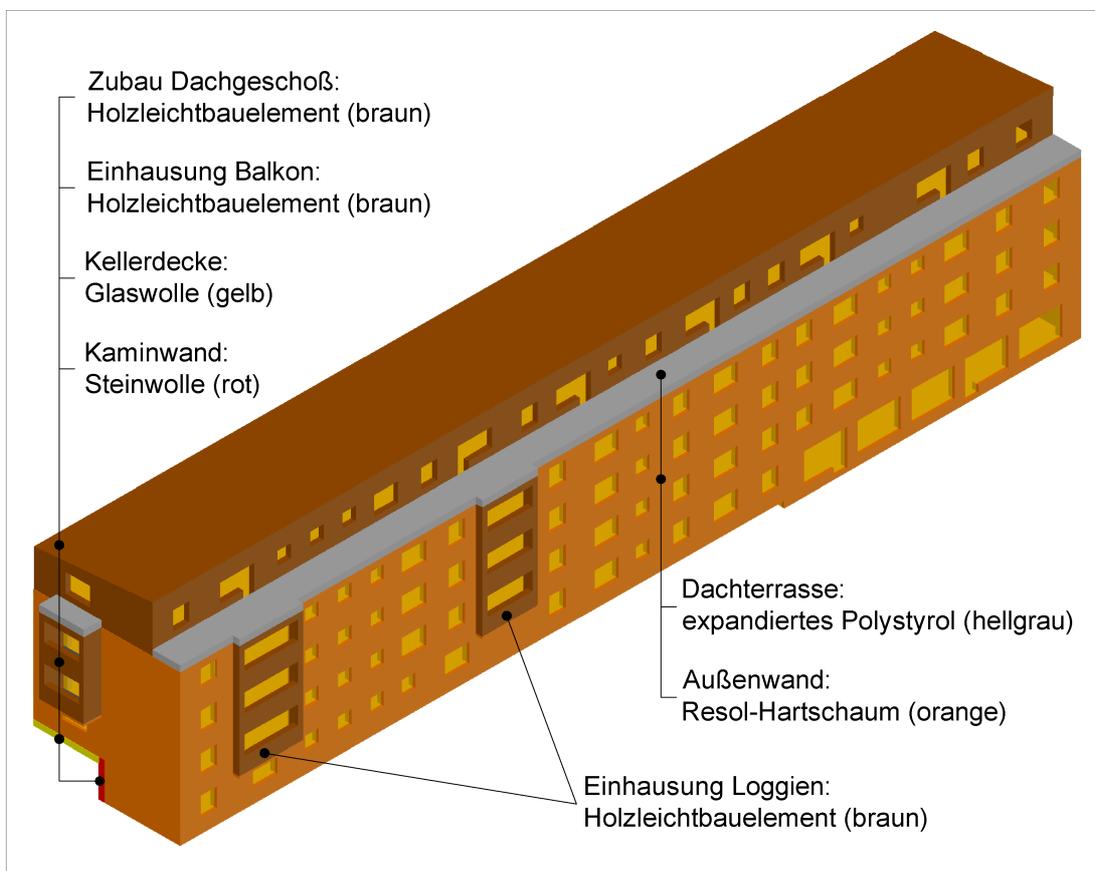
Sanierungsmaßnahmen für die Gebäudeteile der thermischen Gebäudehülle bei der Sanierungsvariante *Passivhaus mit Dachgeschoss* (Ansicht Südwest, M 1:400)
